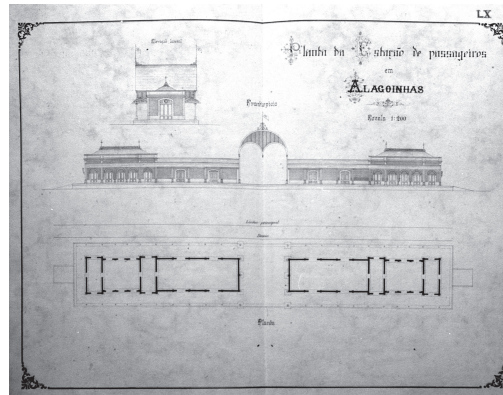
Planta e fachadas da estação de passageiros da Estação São Francisco. Fonte: Argollo (1900).
